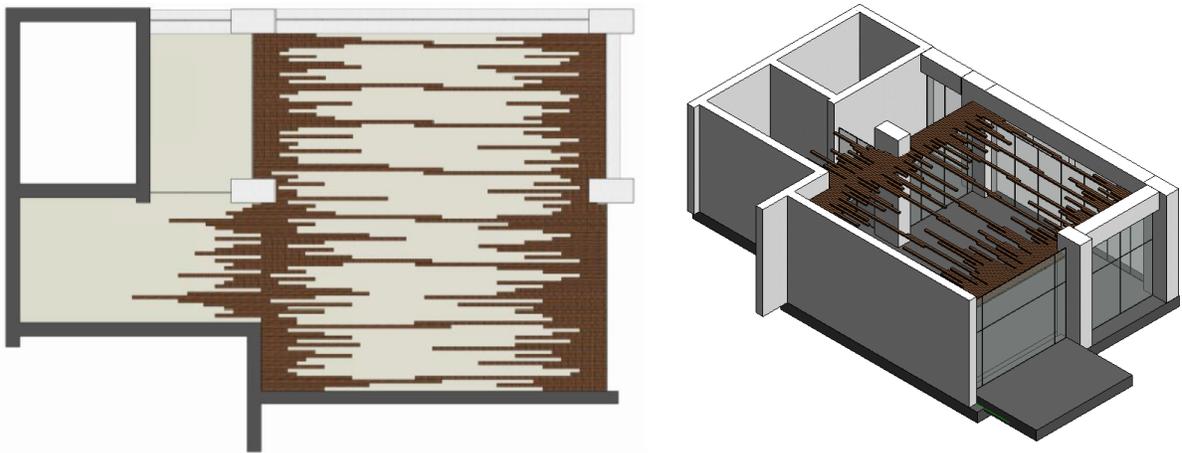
Modulación de vigas de madera en cielo falso Terraza-Bar
